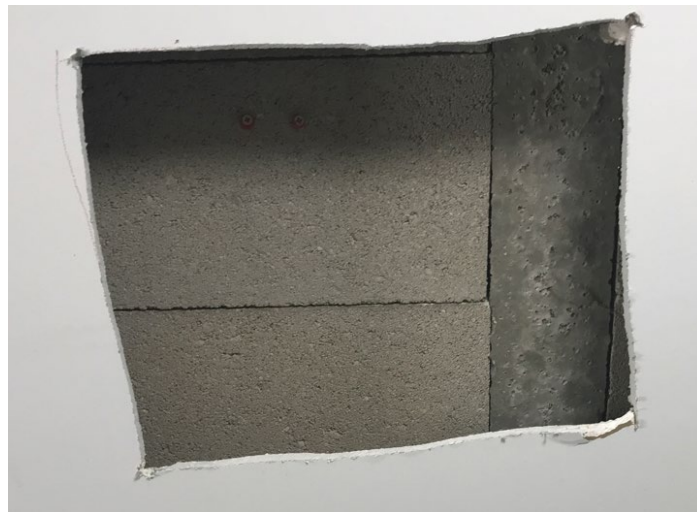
Plancher poutrelles & hourdis (local N.O.33-A)
